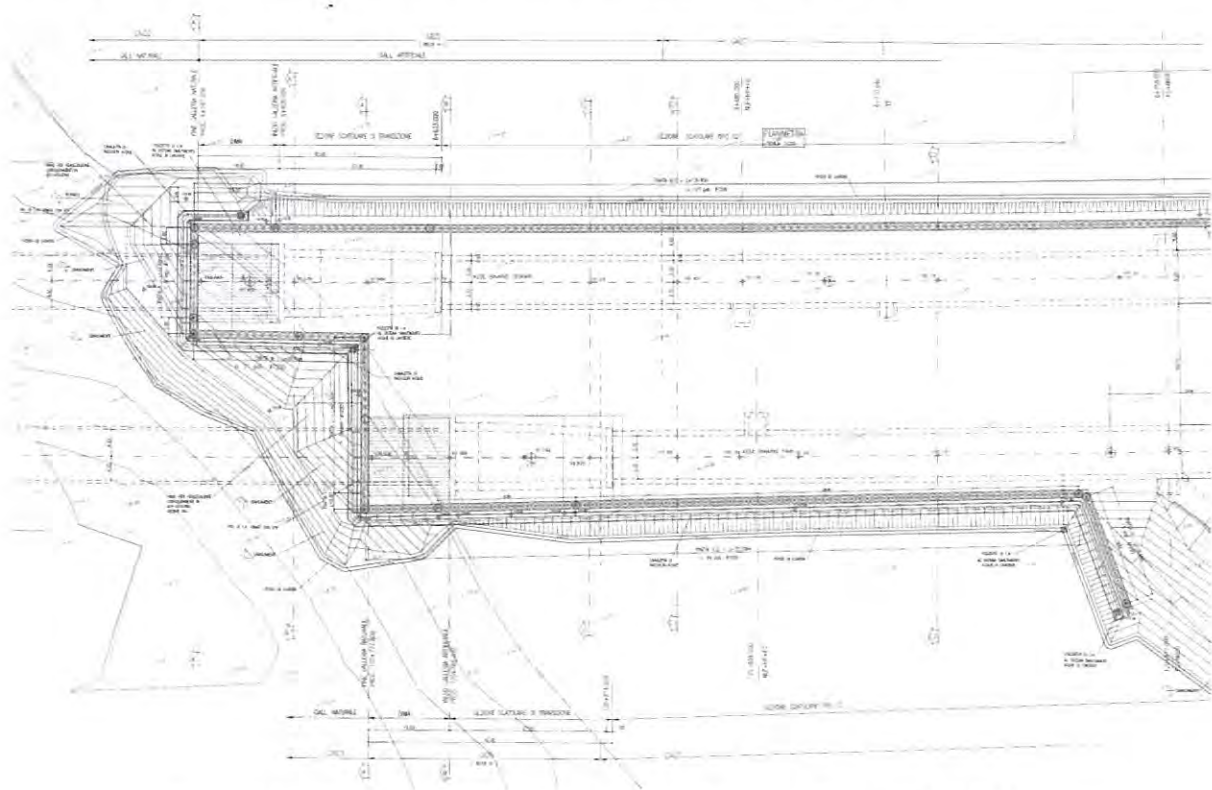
Planimetria di scavo imbocco lato Verona galleria artificiale Lonato
